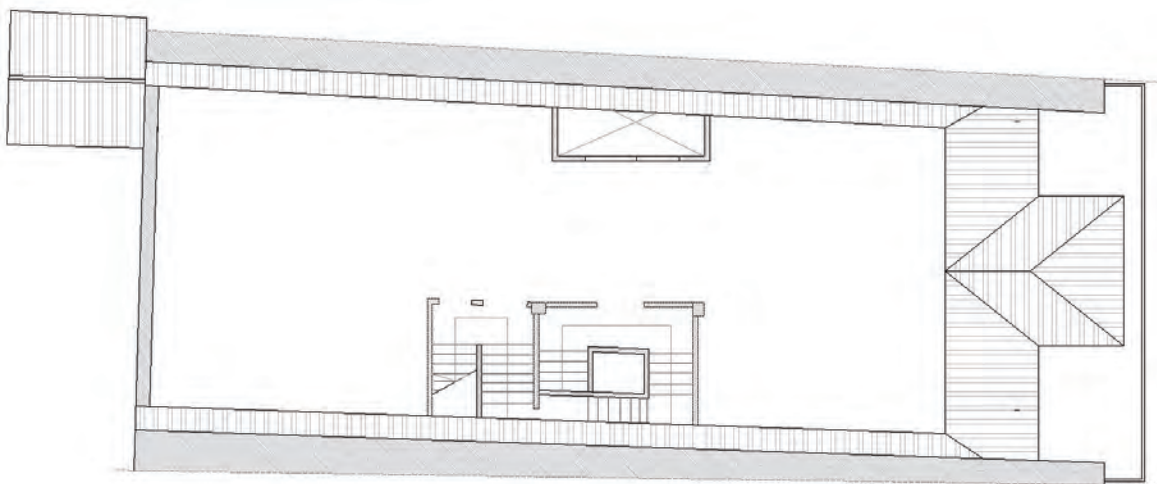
15. PLANTA BAJOCUBIERTA
